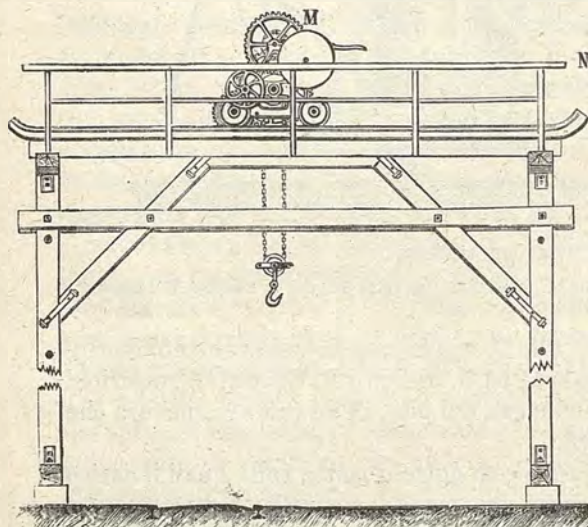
Gru a ponte con motore a mano nella parte superiore.
